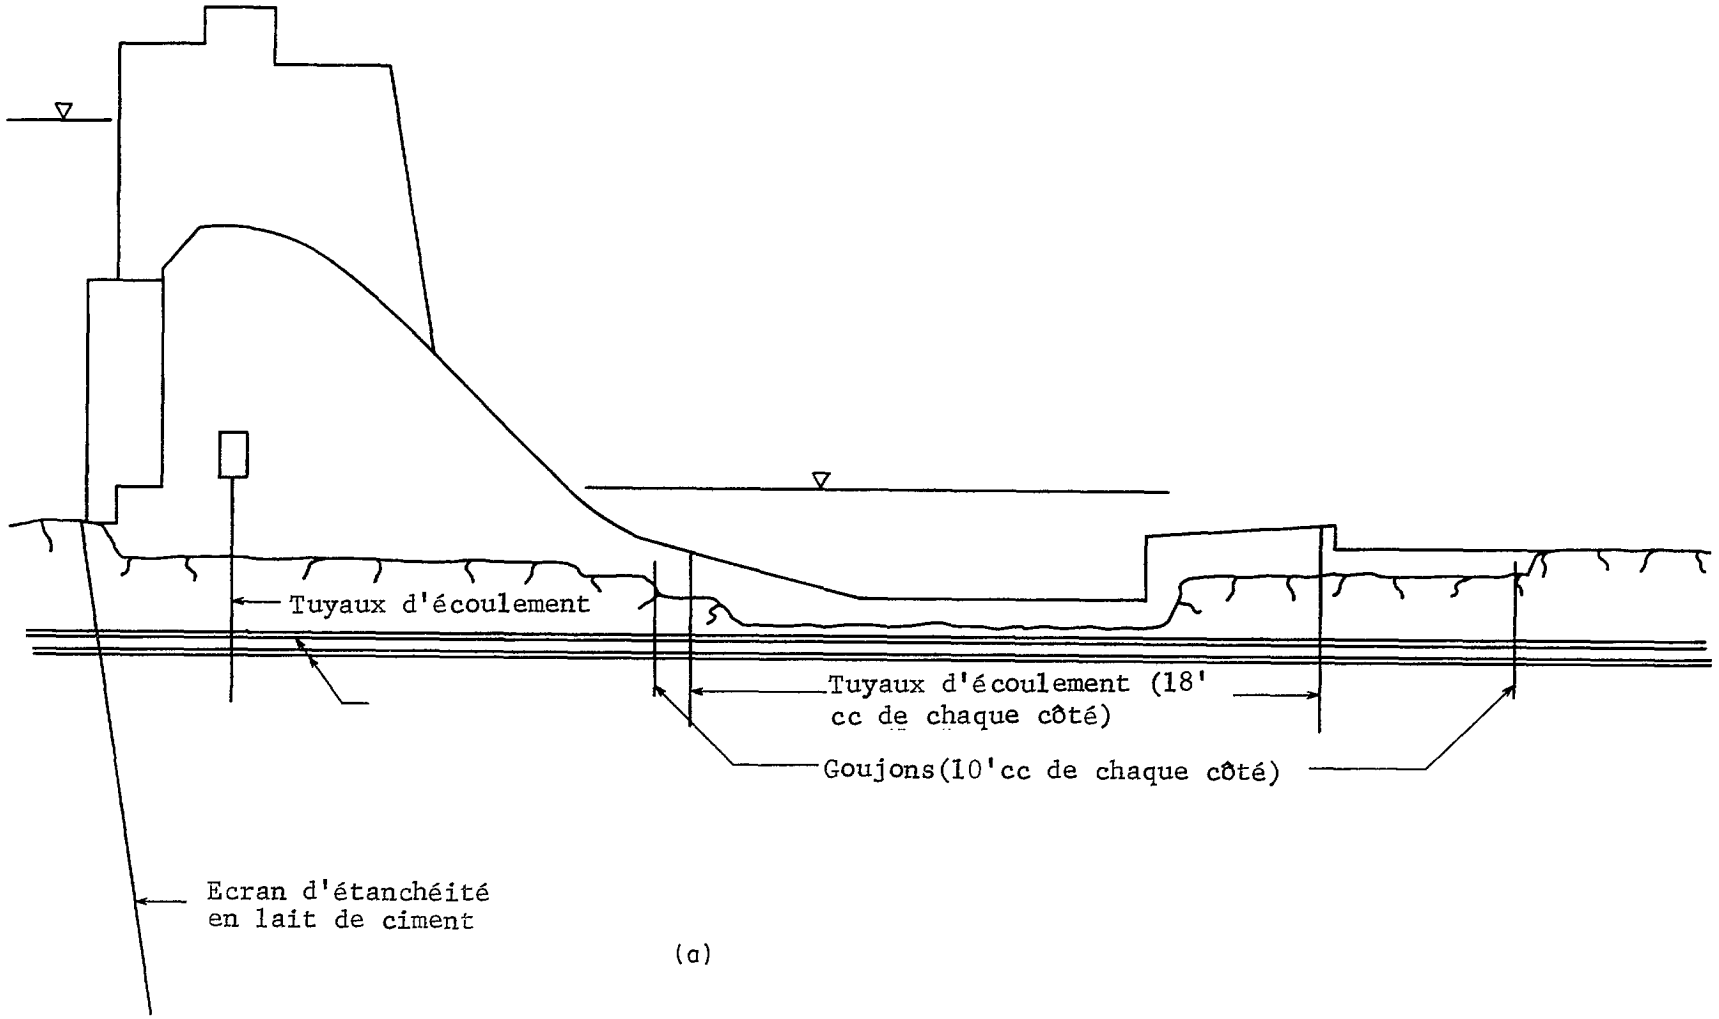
Fondations d'un barrage en zones faibles et certaines mesures de construction qui peuvent être prises.
